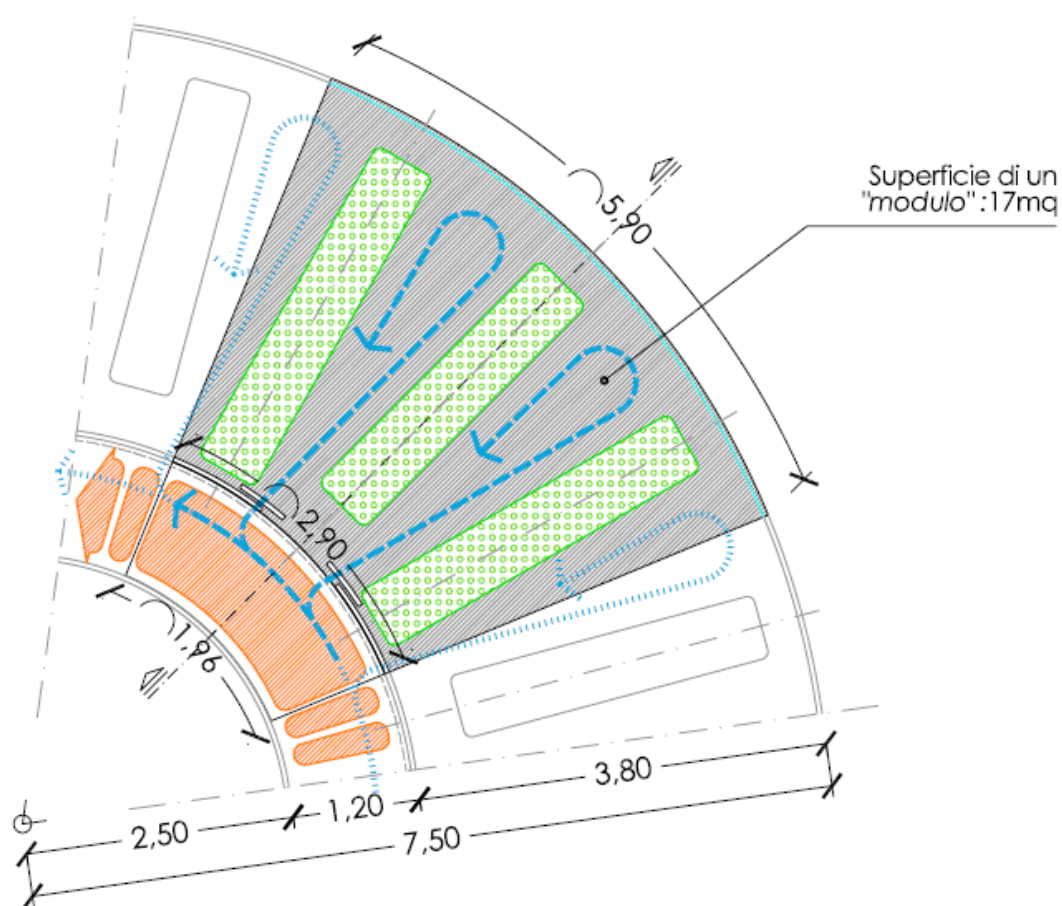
Torre Cilindrica, sezione verticale di un modulo base
